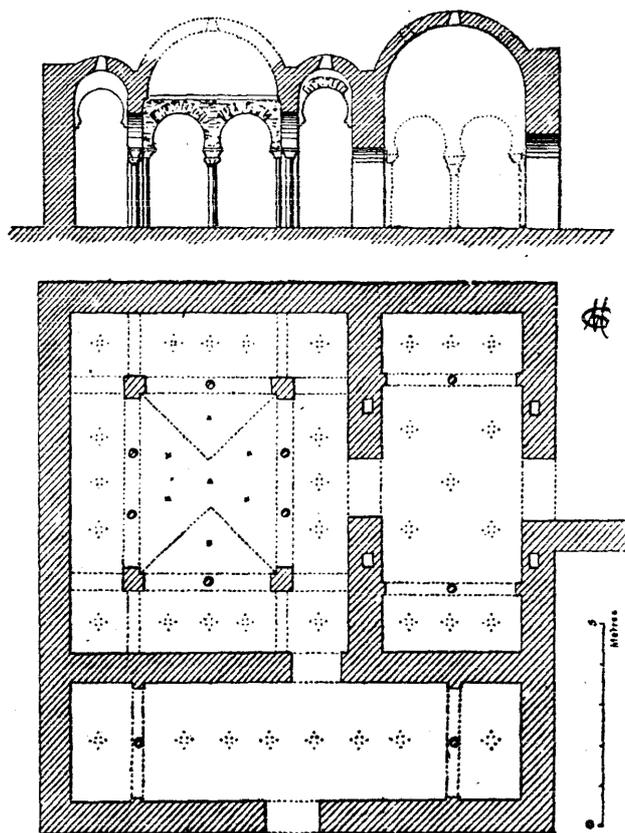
Plano y sección del Baño Árabe según Gómez Moreno.
